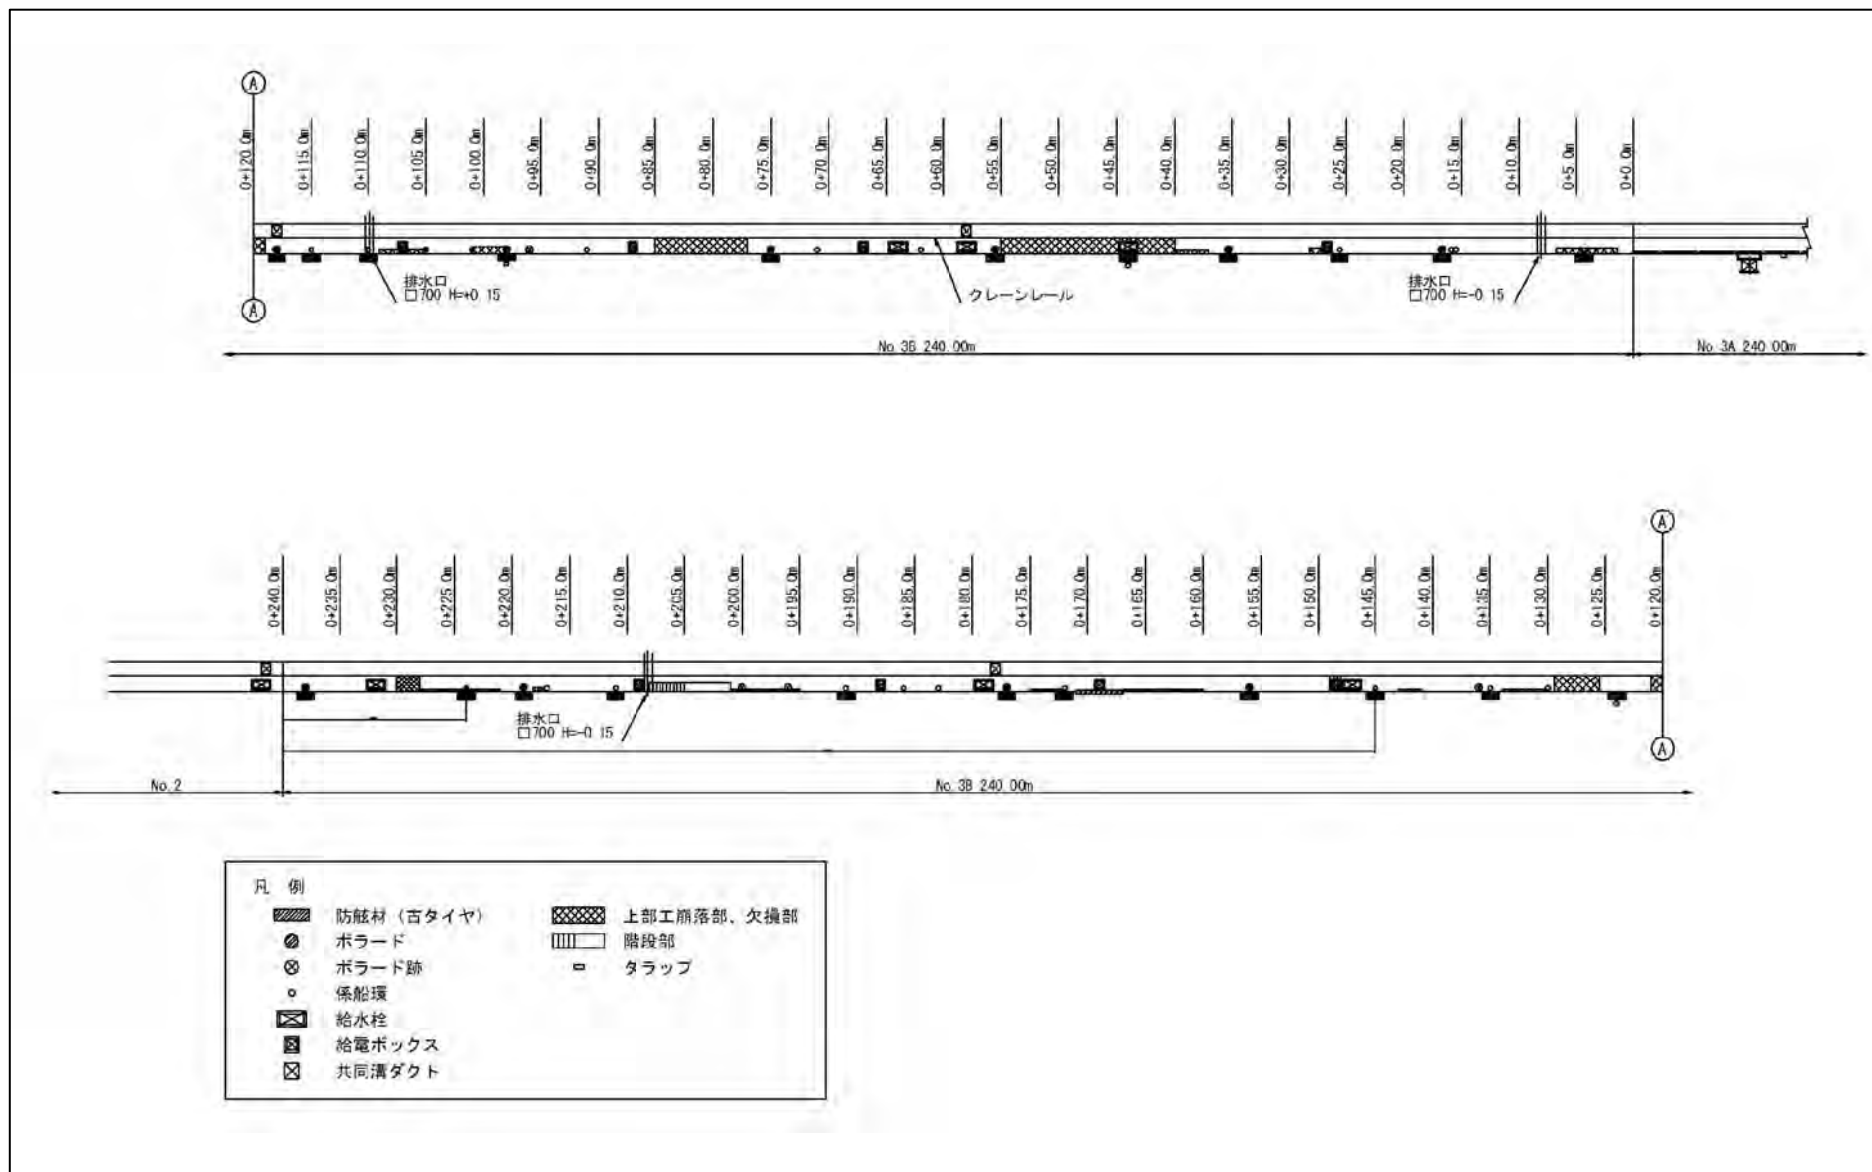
ナミベ港 No. 3B 岸壁現況平面図
